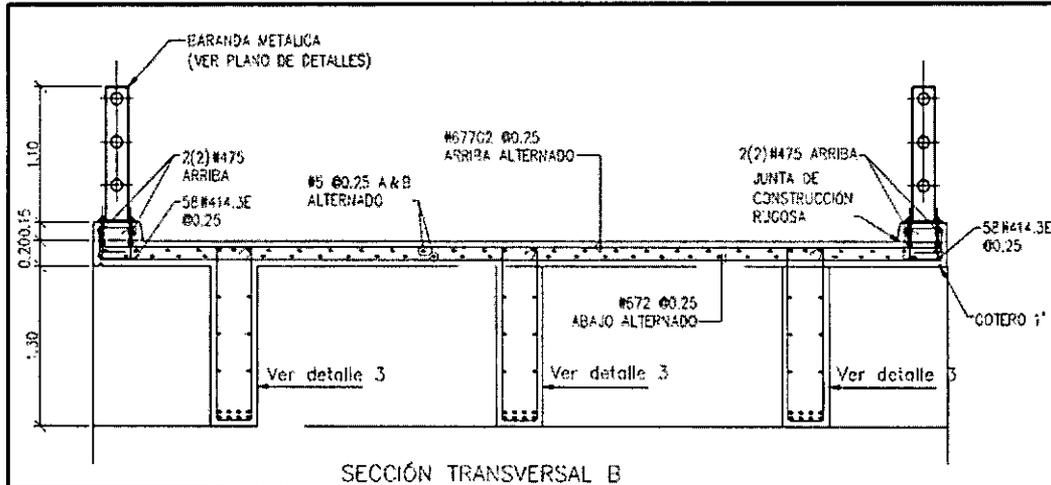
Detalle hidráulico de la sección del puente. Vista transversal.
